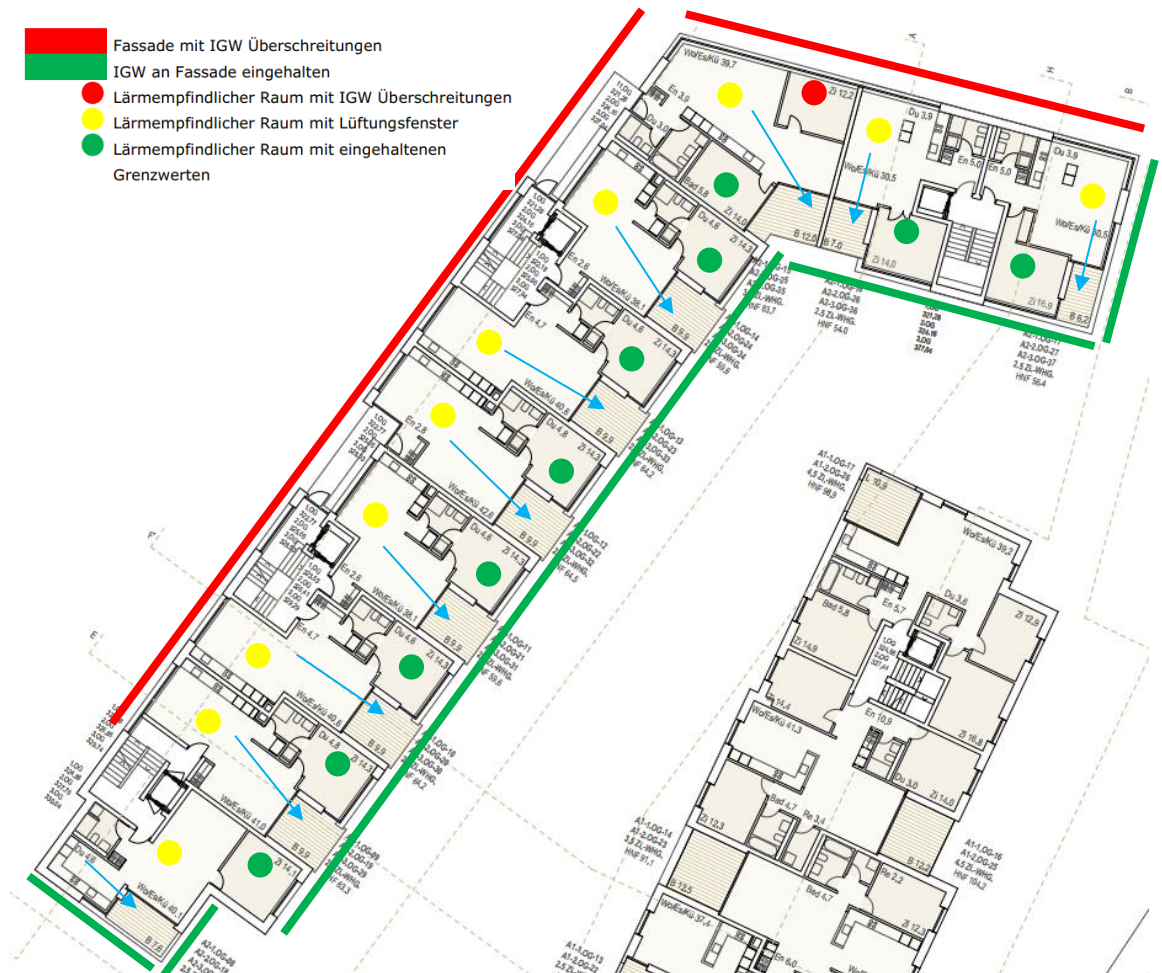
Grundriss 1.- 4.Obergeschoss Haus A2
